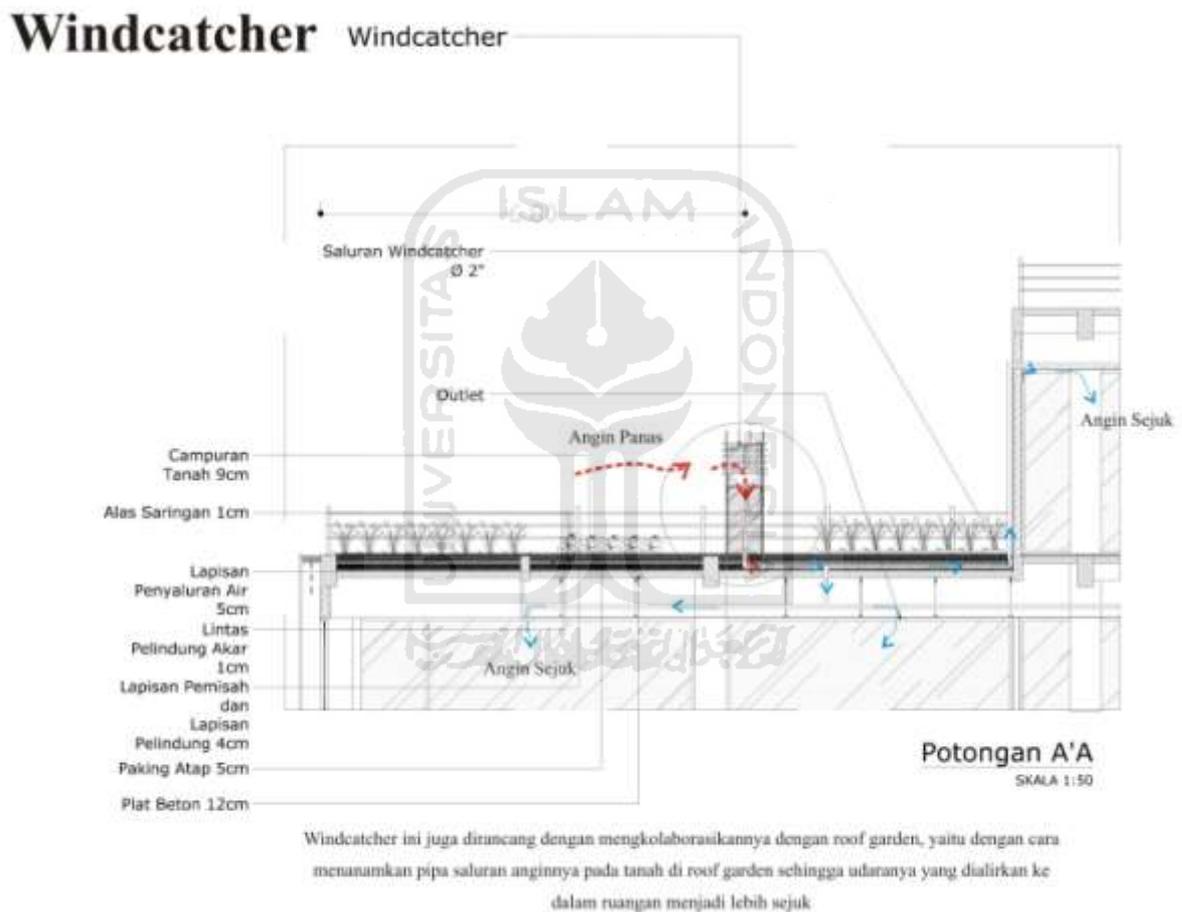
Konsep Indoor Garden dan Roof Garden
